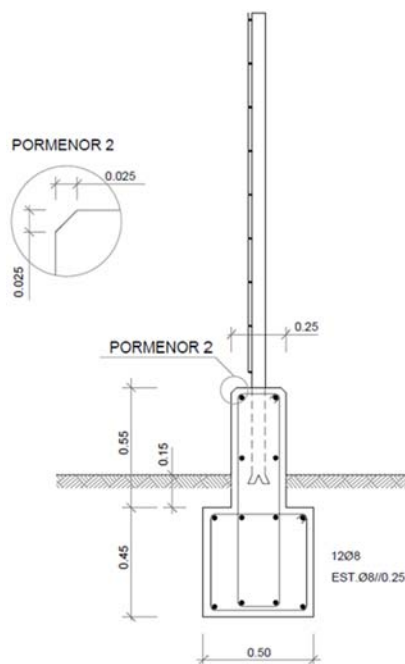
Geometria e pormenorização de armaduras no murete de apoio
